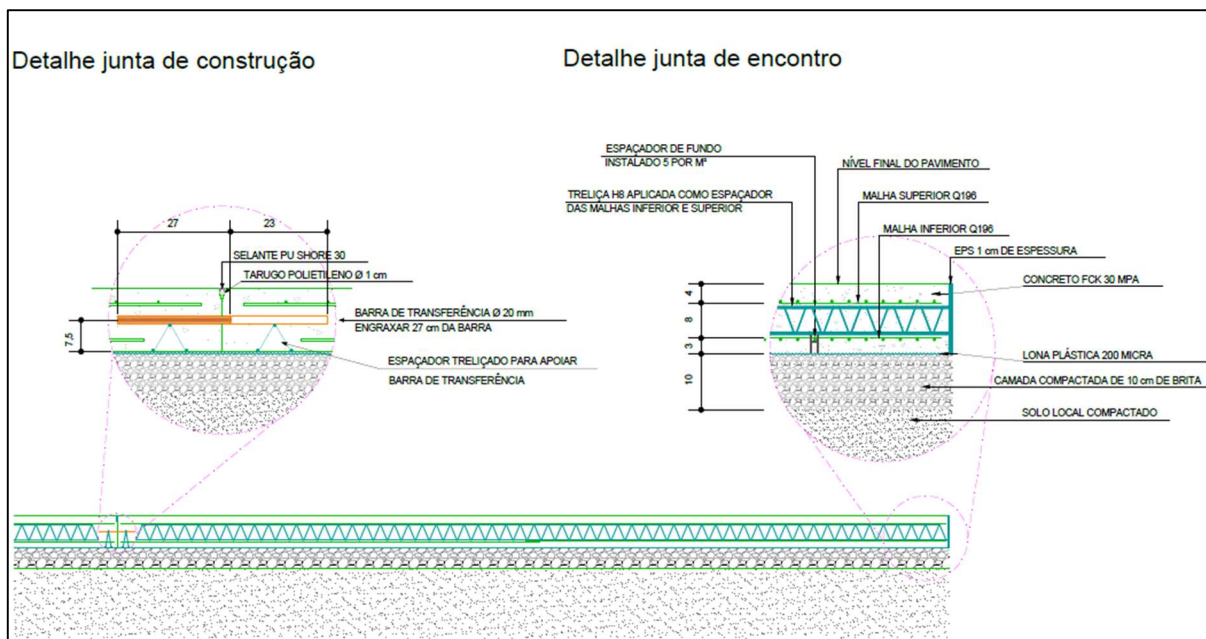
Detalhamento de execução do pavimento em concreto armado.
